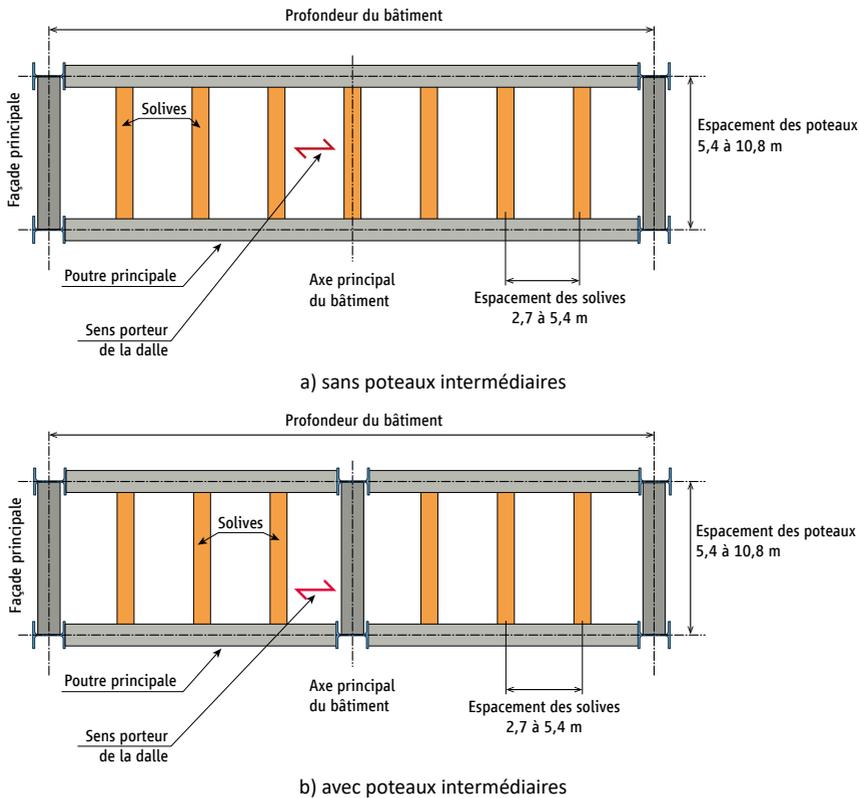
Configurations de trame avec solives parallèles à l'axe du bâtiment
